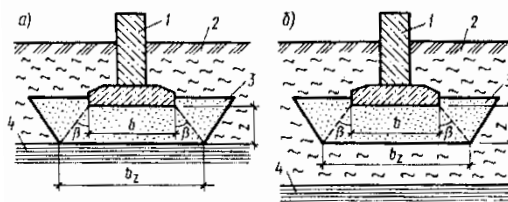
Устройство песчаных подушек при малой (а) и большой (б) толщине слабых грунтов:
